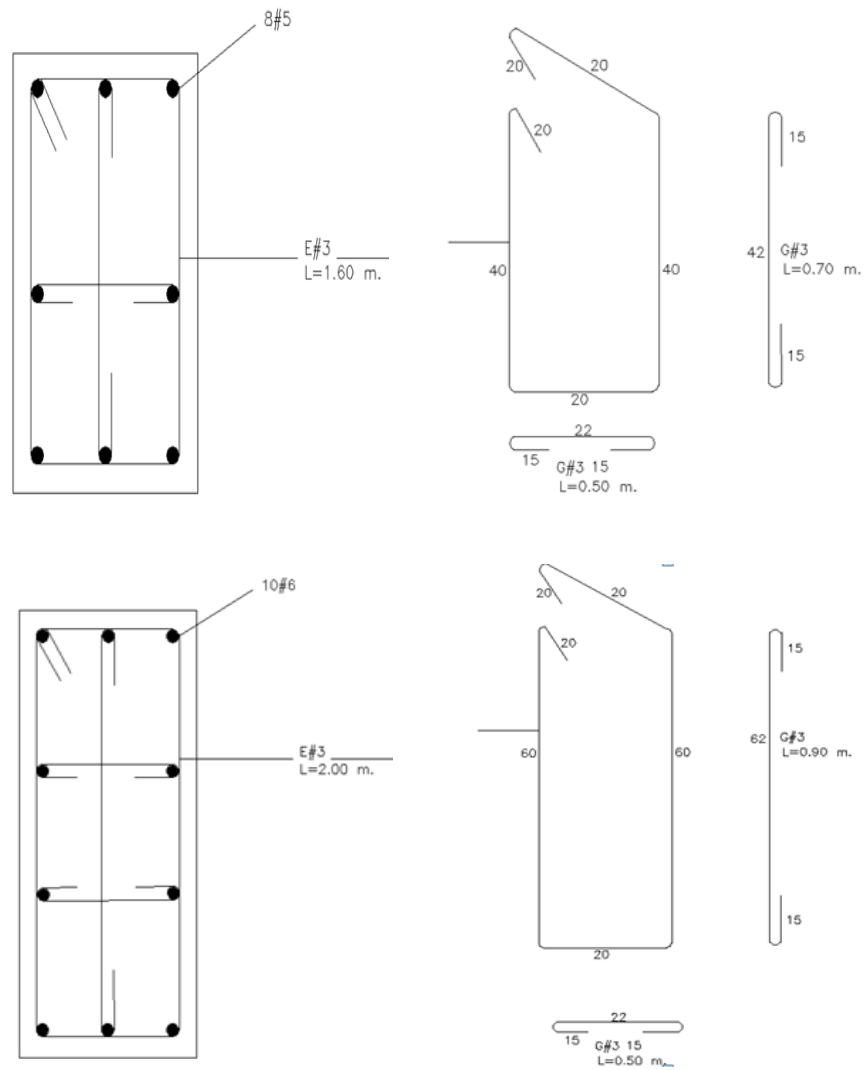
Sección y Detalles de Columnas. (Fuente: GRACOL. SAS).
